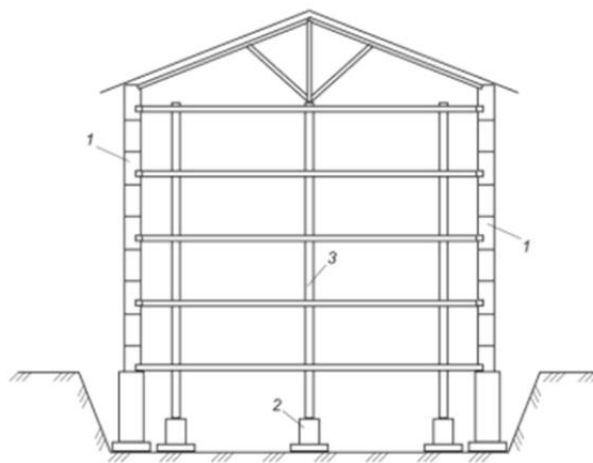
Реконструкція будівлі за допомогою вбудованої системи: 1 – існуючі огорожувальні конструкції; 2 – фундаменти вбудованої системи; 3 – вбудовані конструкції
